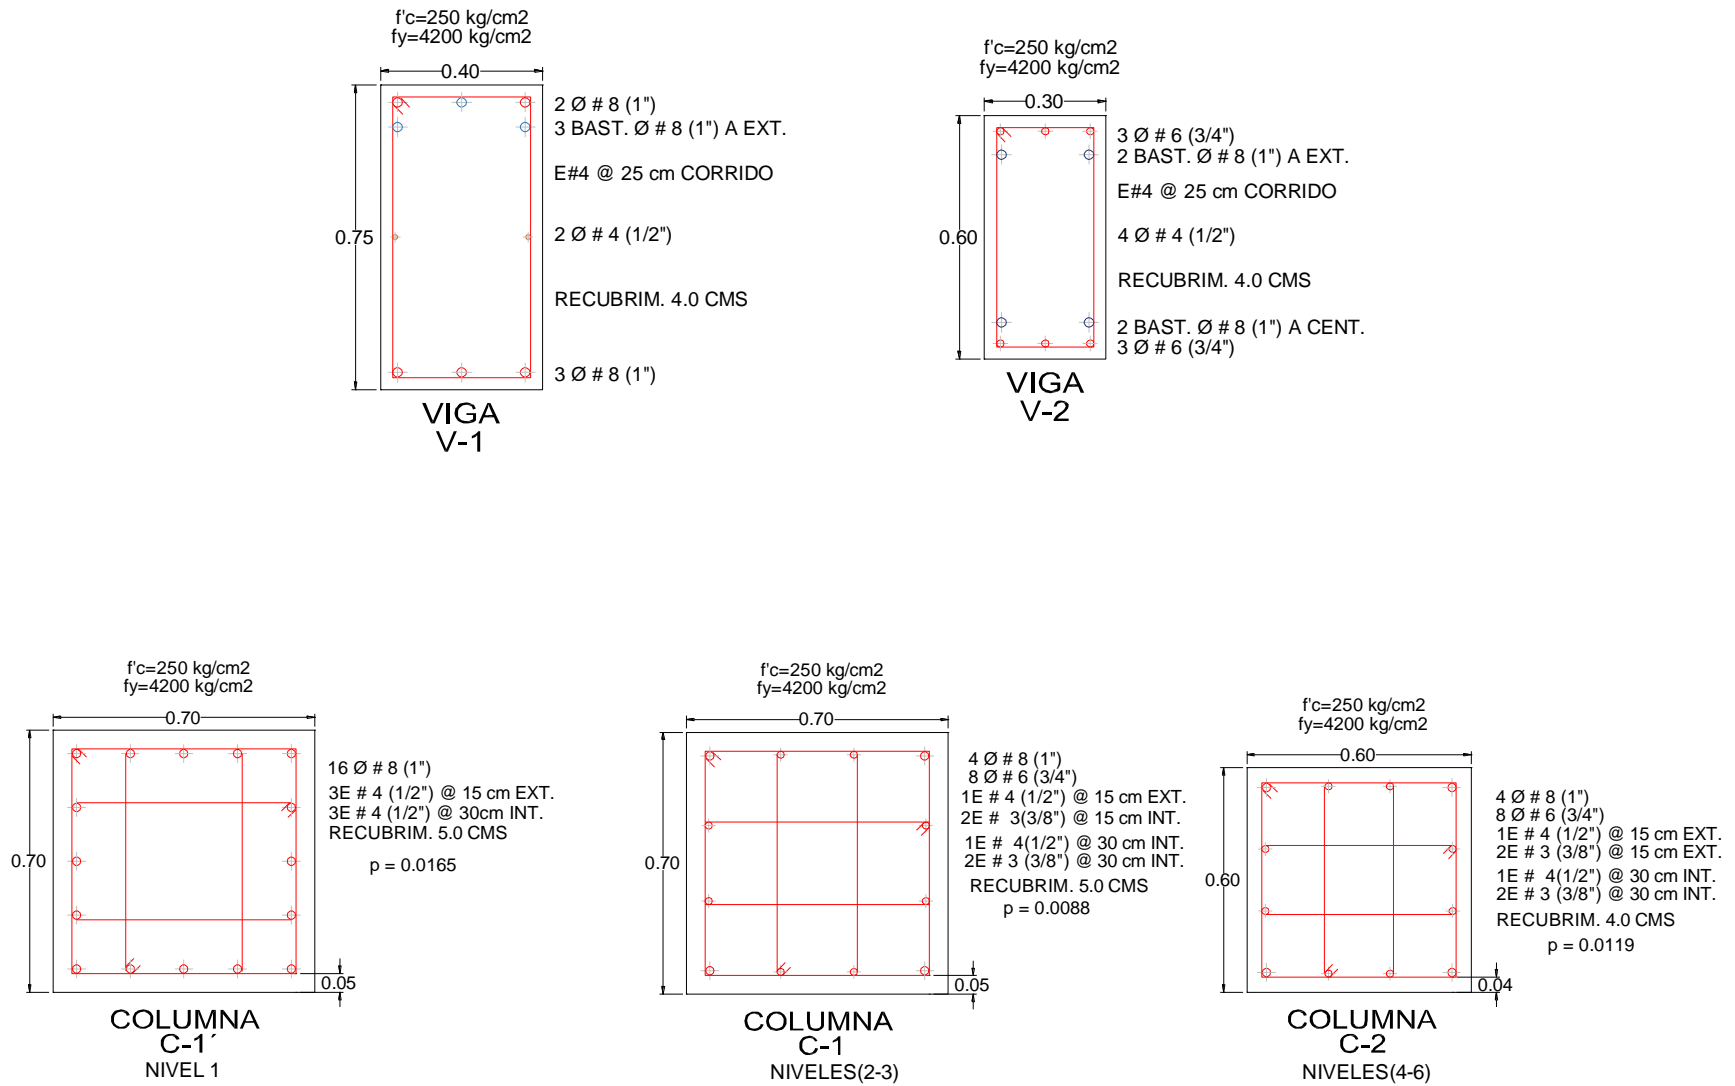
Detallado de armado de vigas y columnas del marco de 6 niveles con base a la hipótesis de las NTCC-04.
